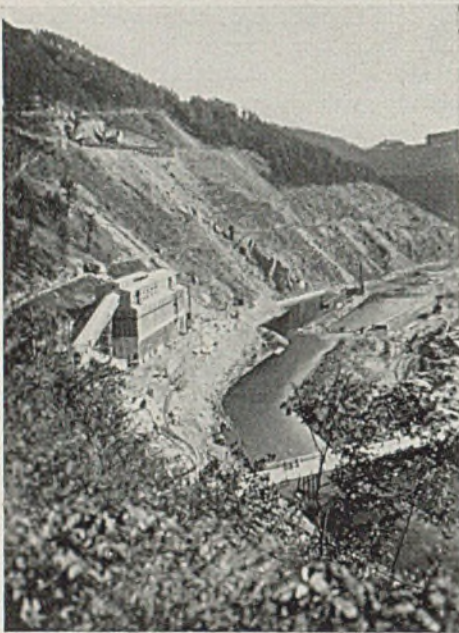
Baustelle der Sperrmauer bei Hohenwarte mit dem Mischsilo für den Beton.
